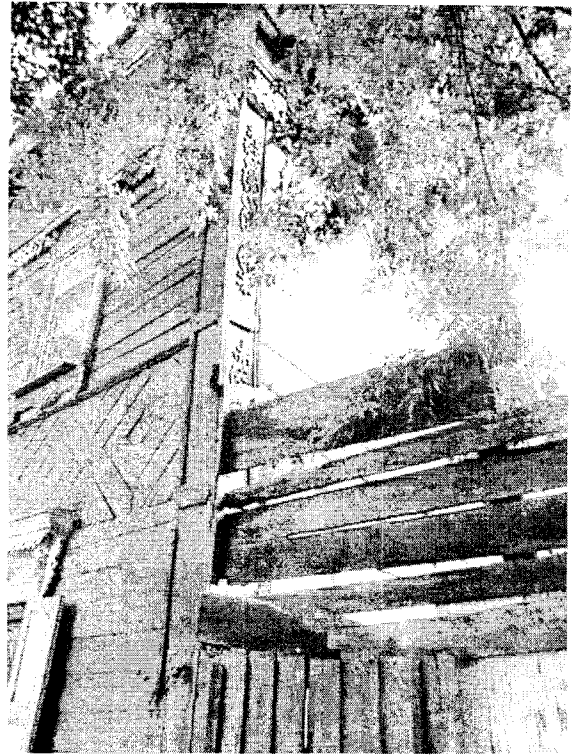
, 12 - Фрагменты продольного (юго-западного) фасада жилого дома (лит. А). Огибающие лопатки, фриз, карниз, наличники оконных проемов 1-го и 2-го этажей
